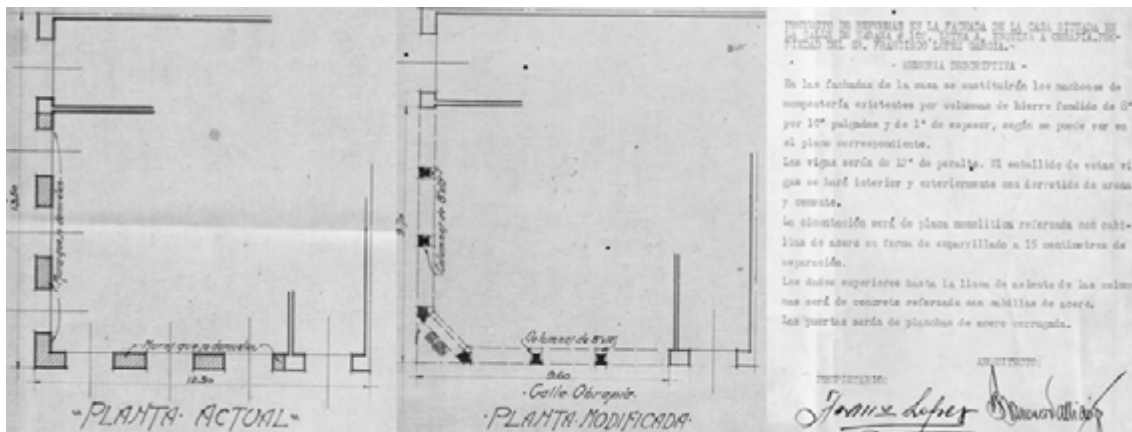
Proyecto de chaflán en planta baja calle Habana 102 A.NAC. Legajo 9 H
